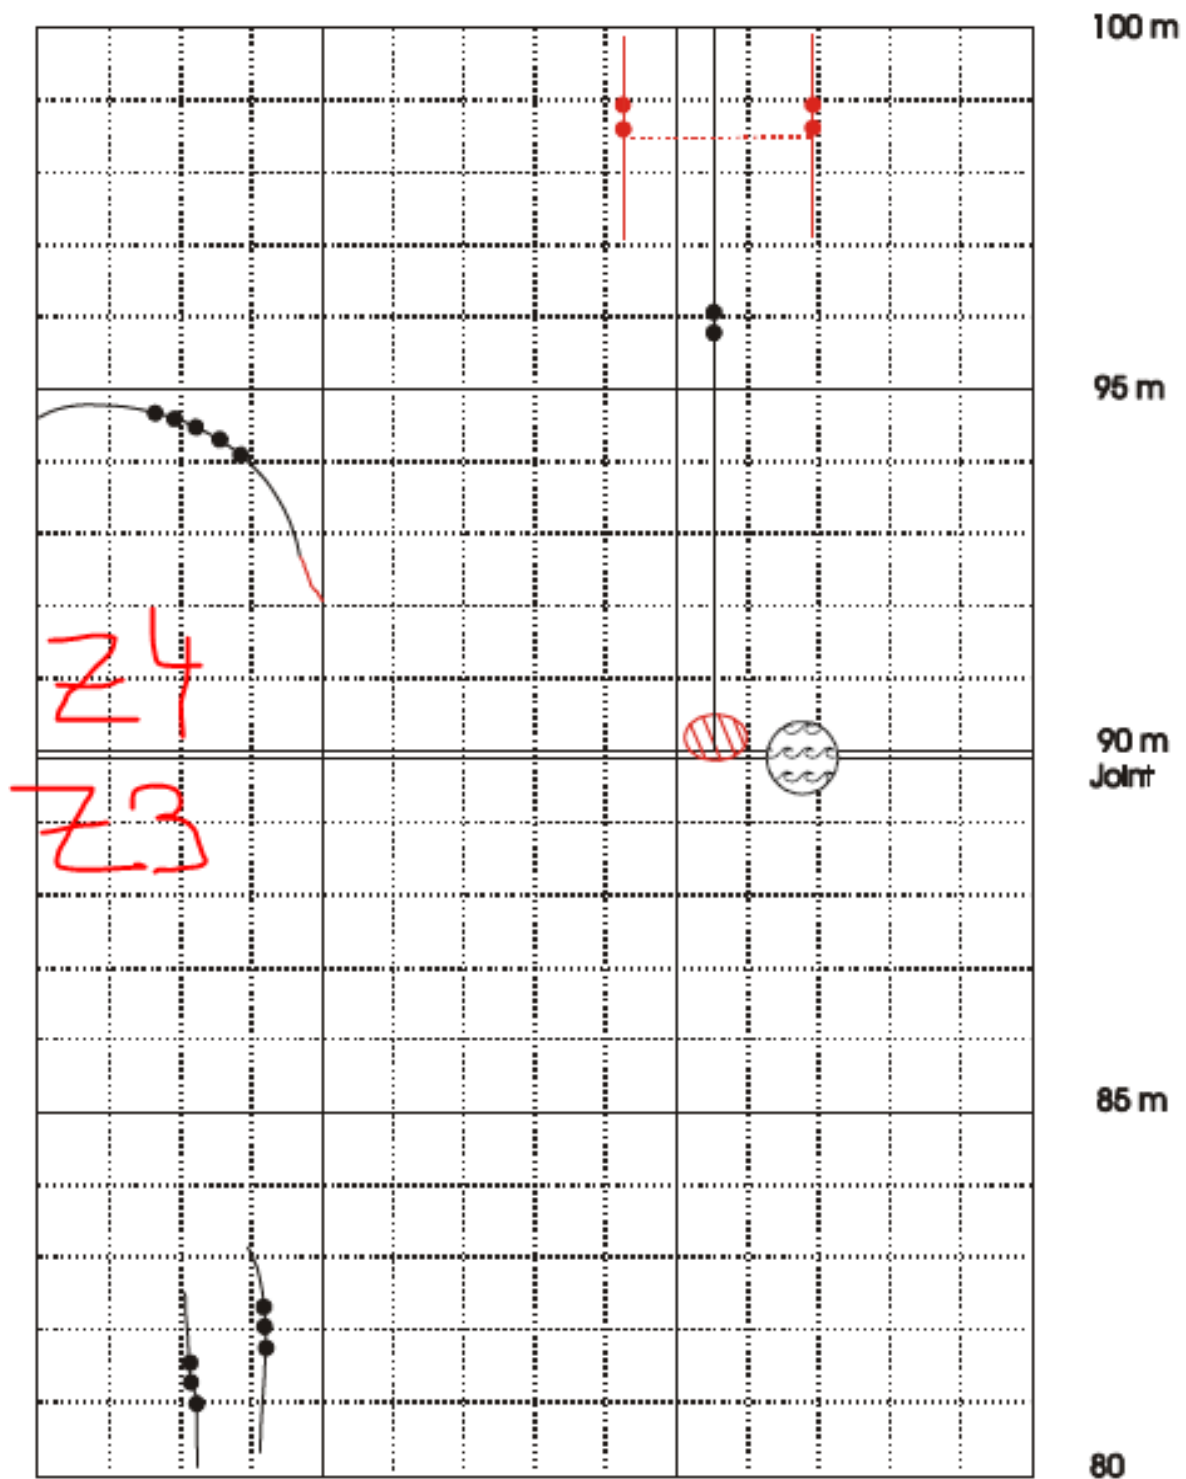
Planche de fissuration travée Nord-Ouest Zone 3
